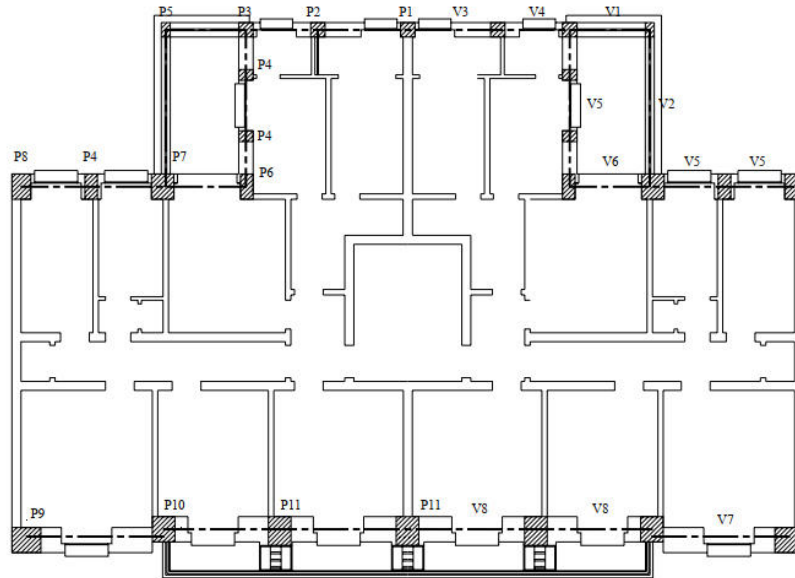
Planta de estrutural de restantes pisos do edifício existente em estudo (Lamego, 2014)
